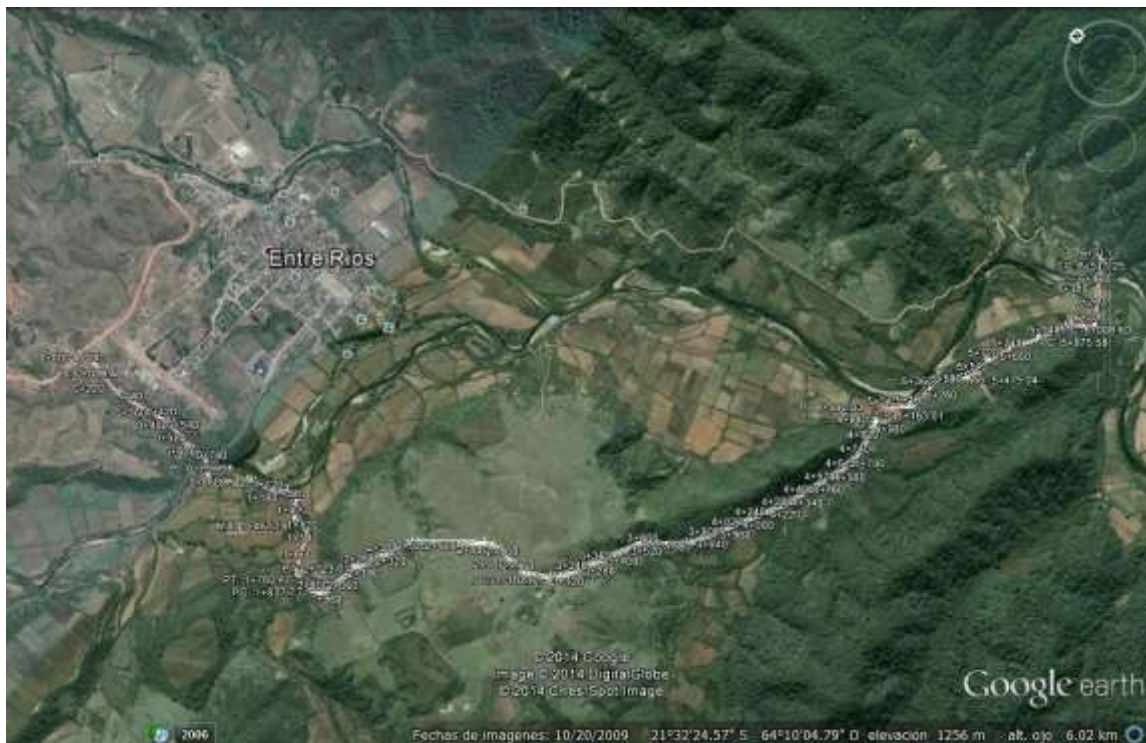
Planteamiento y trazo vial Alternativa I (Fuente: Imagen Google Earth;
